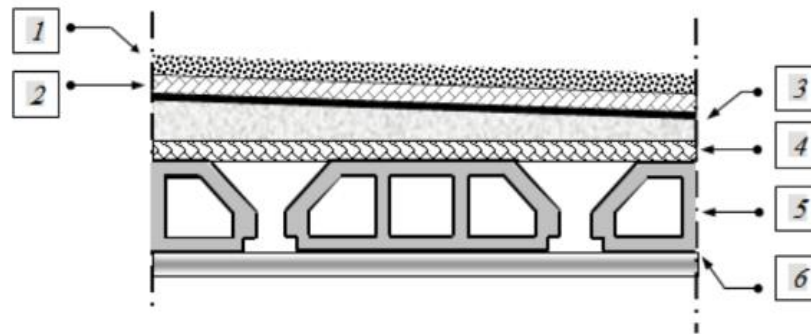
Coupe verticale du plancher terrasse à corps creux.
